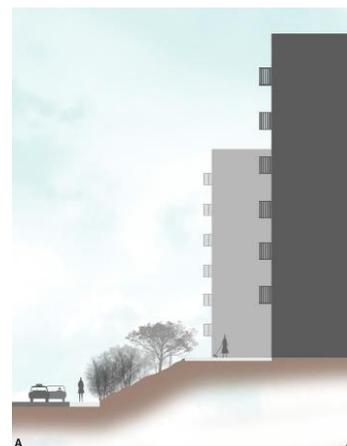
Corte esquemático transversal AA' (Fonte: Autor)
